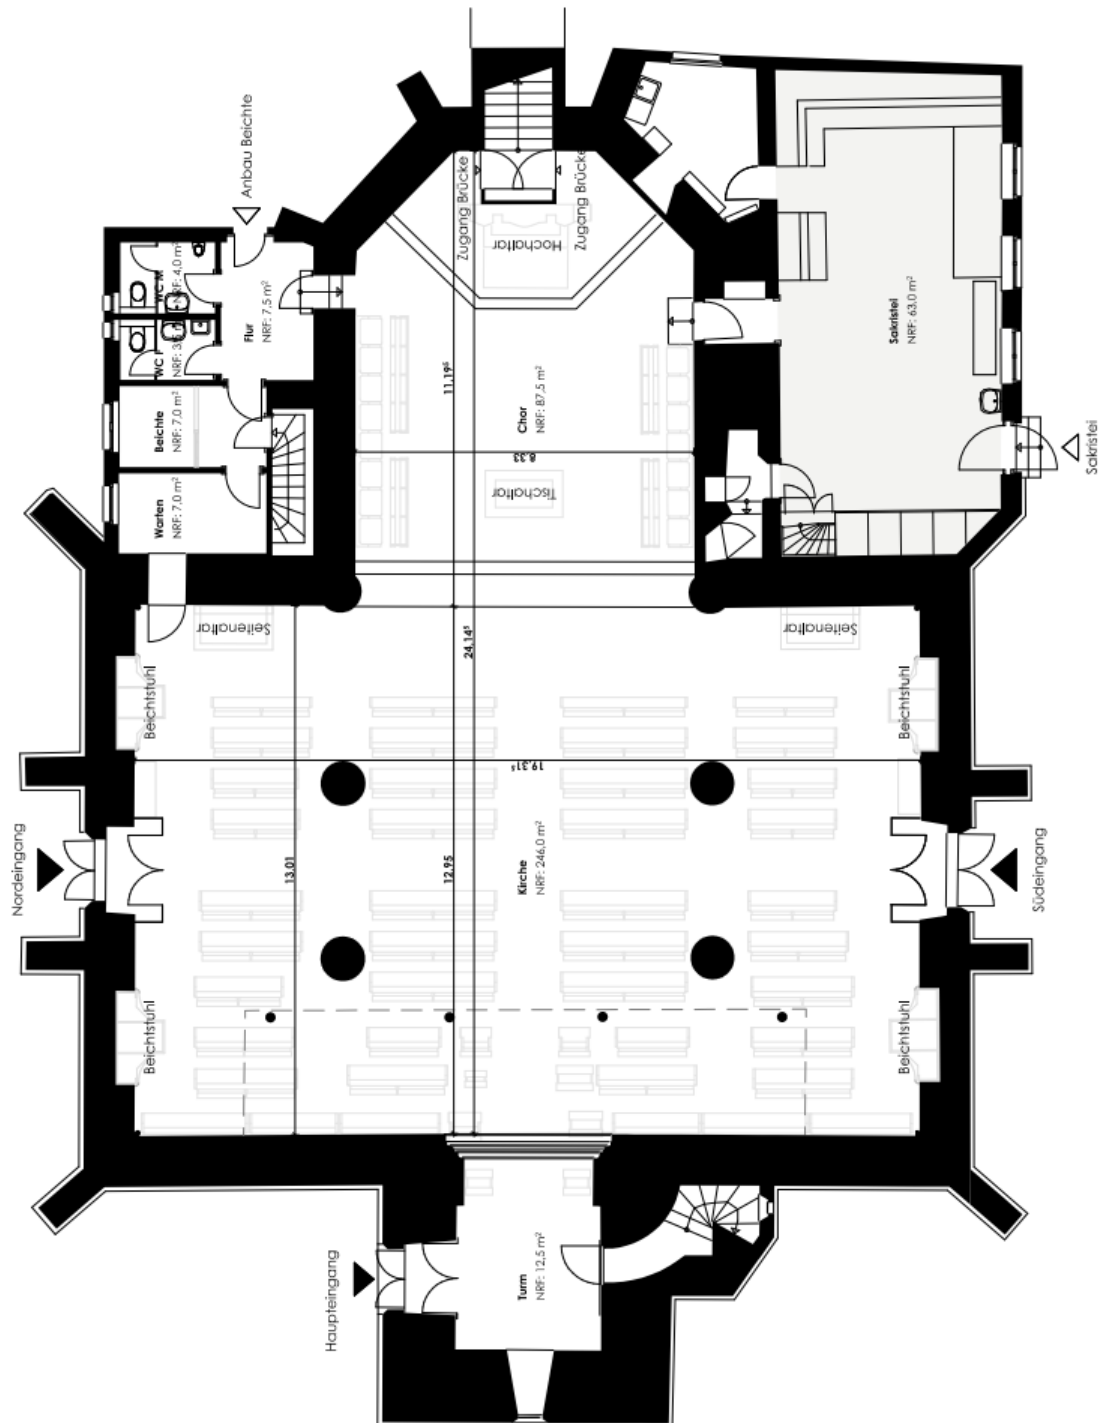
Grundriss der Marienkirche im EG, Brewitt Architektur 2025
